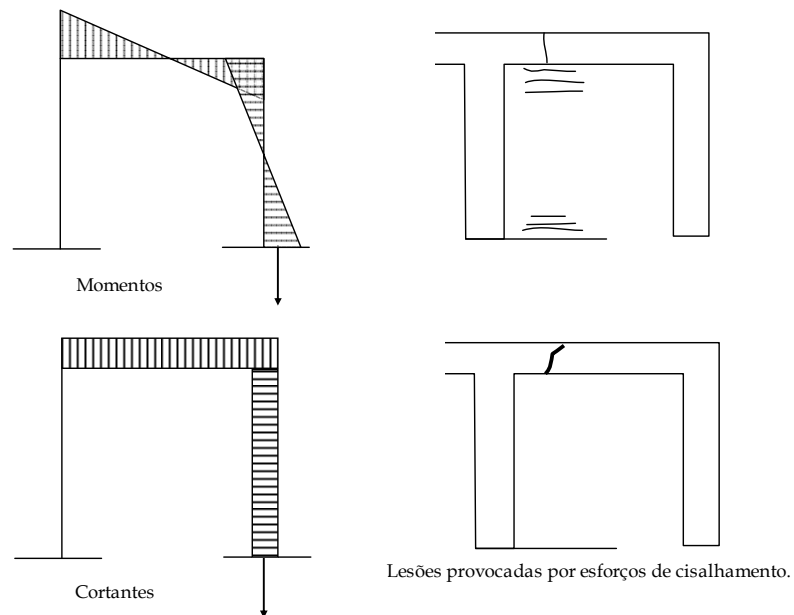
Prováveis diagramas de esforços e fissuras em estruturas de concreto por recalques de fundações de pilares nas extremidades (adaptado de MAÑÁ, 1978 *apud* MILITITSKY et al., 2005).
